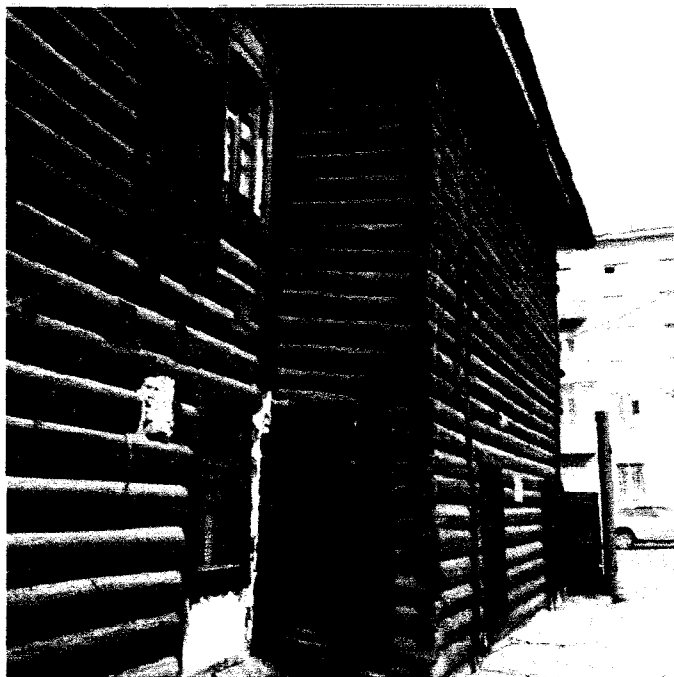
Оконный проем бокового (северо-западного) фасада в уровне 2-го этажа
